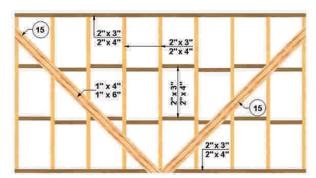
21: Muro arriostrado con tabla de madera encastrada, pieza  $N^{\circ}$  15.
